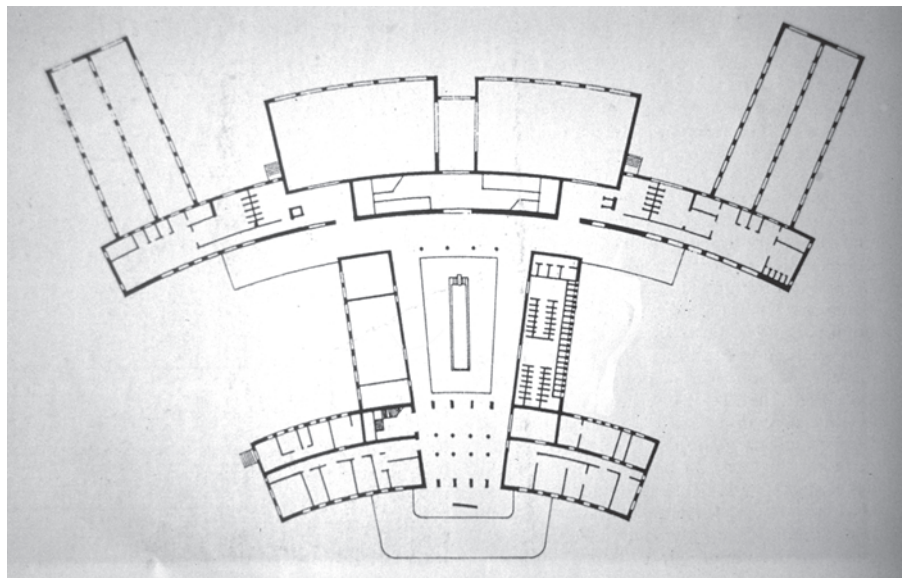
Ferienkolonie „Costanzo Ciano“: Grundriss EG
